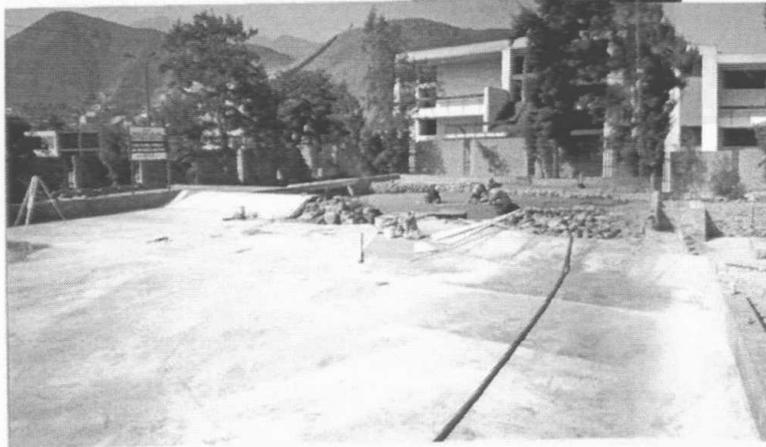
Vista de la construcción del dique derecho en la zona del embalse
